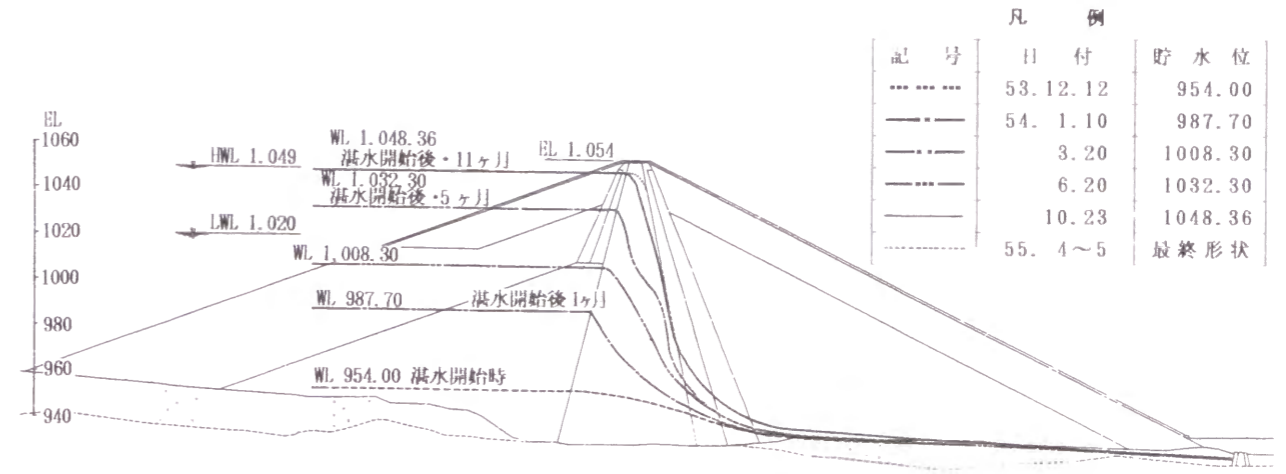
七倉ダムの標準断面図および浸潤面分布図
